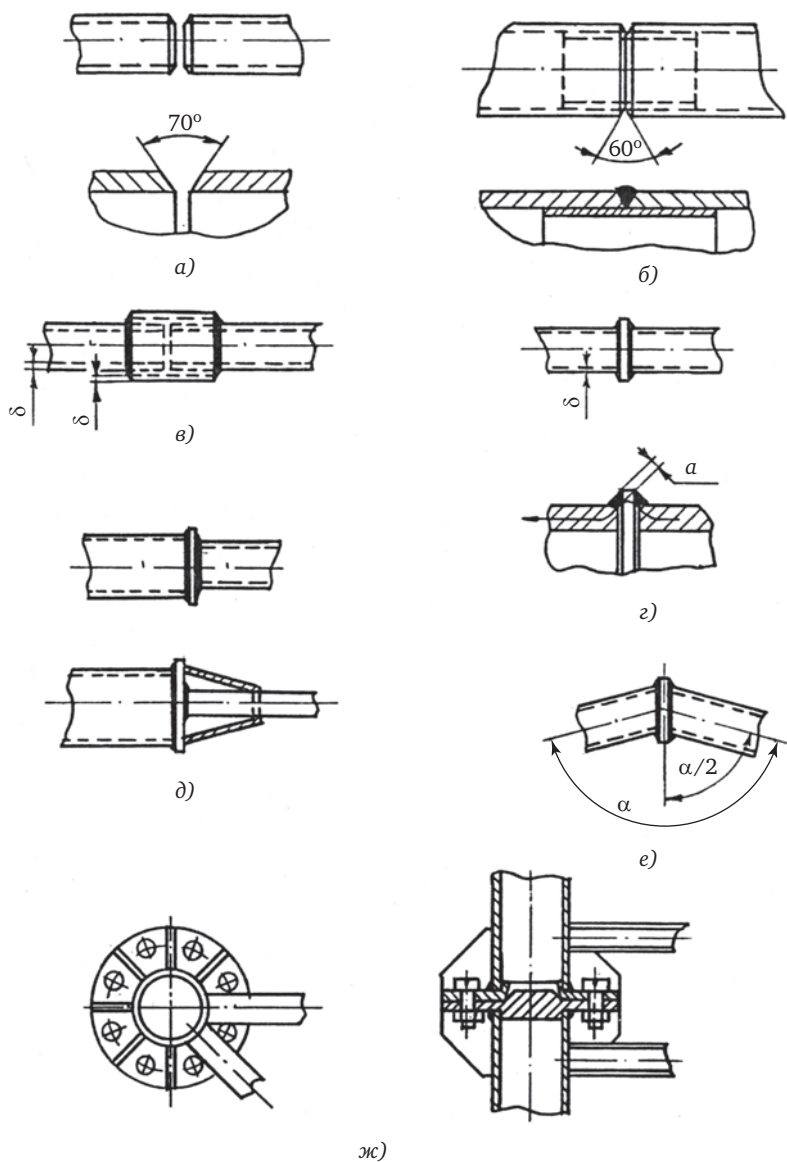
Схемы соединений трубчатых стержней встык:
